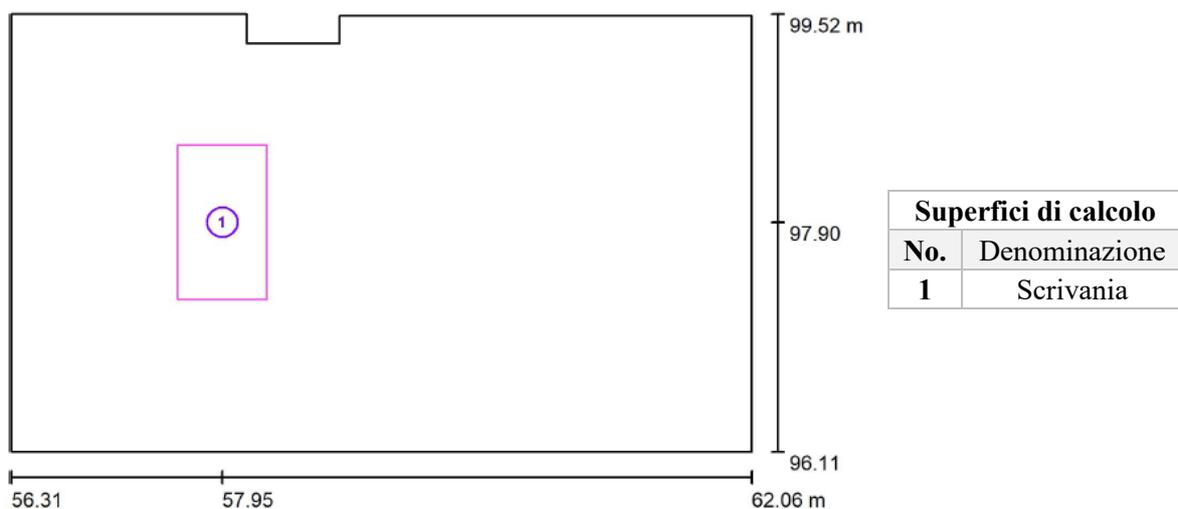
Disposizione in pianta delle superfici di calcolo.
